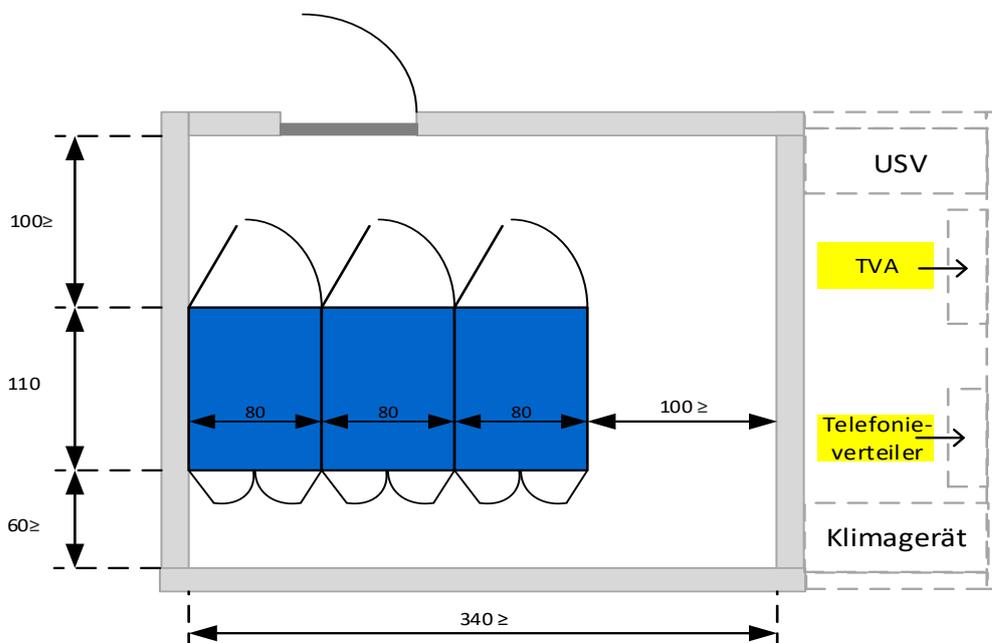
Raum-Layout für einen Raum mit 3 Schränken (alle Masse in cm).
